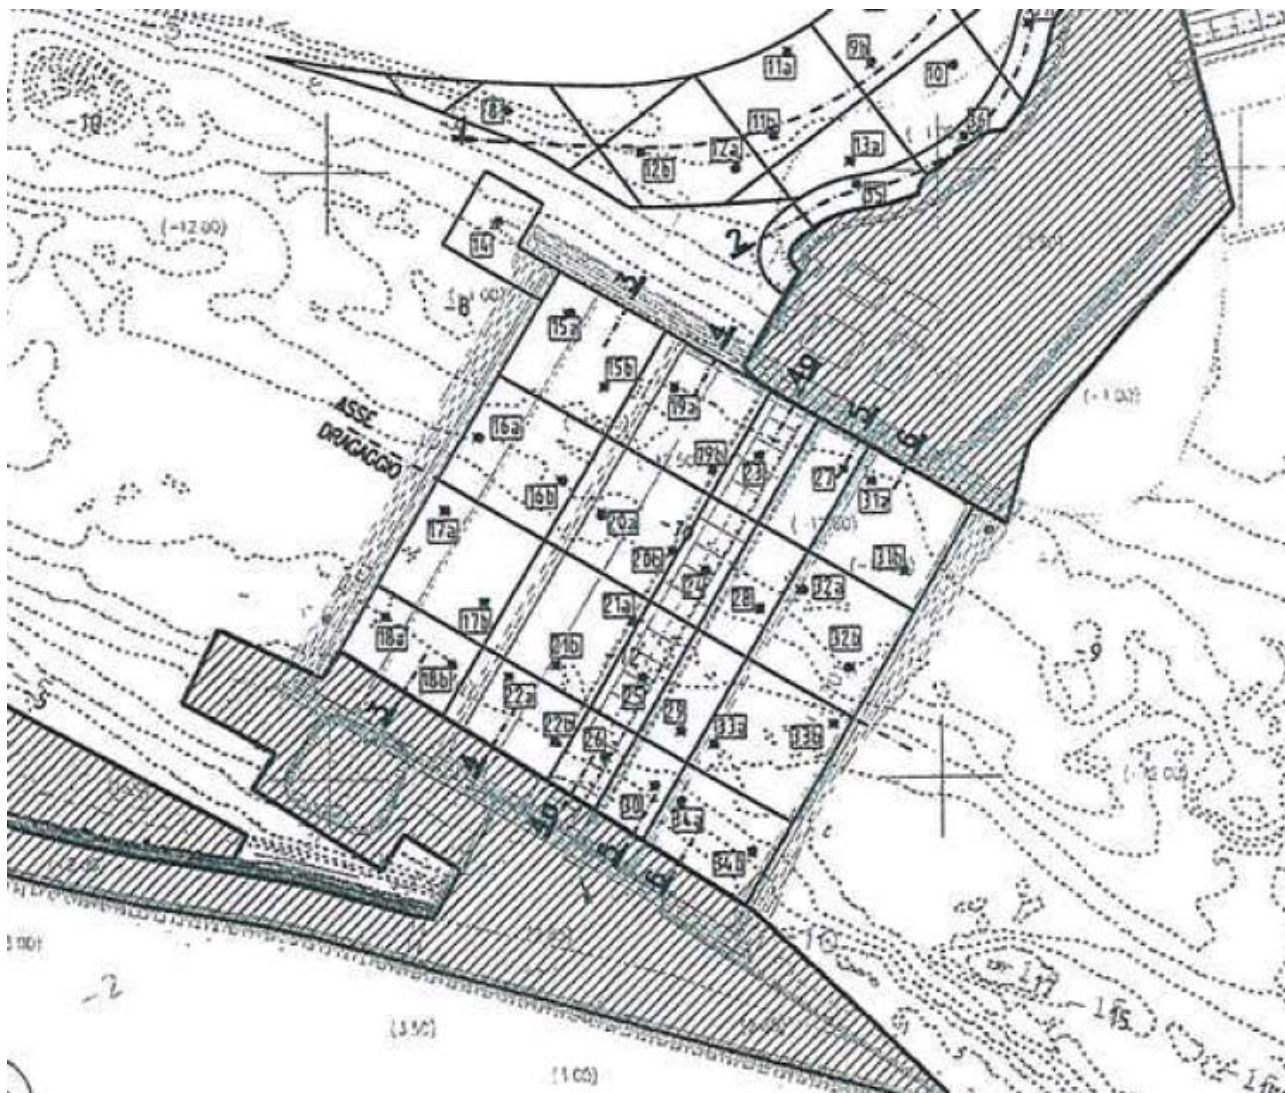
Planimetria dello studio B.6.90 con la localizzazione dei punti di prelievo delle carote di sedimento.
